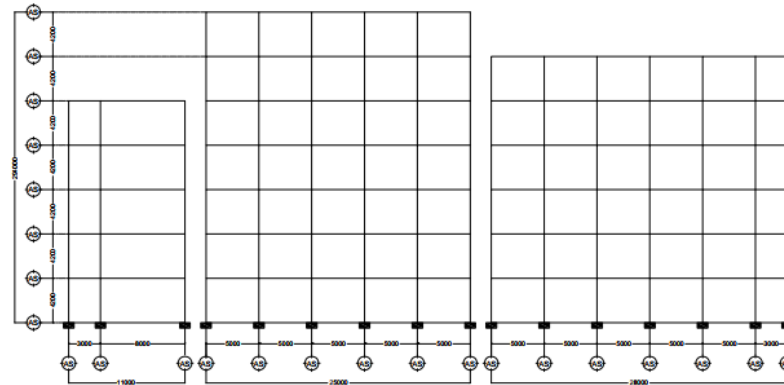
Rencana Balok dan Kolom Lantai 5
